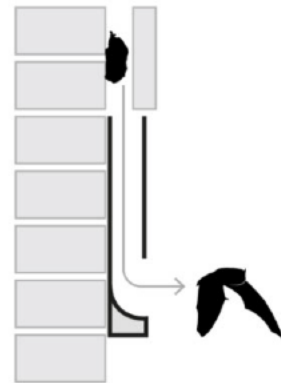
Detail gevelbetimmering voor vleermuizen (afbeelding gegenereerd met ChatGPT (DALL-E) Open AI, 2026)
